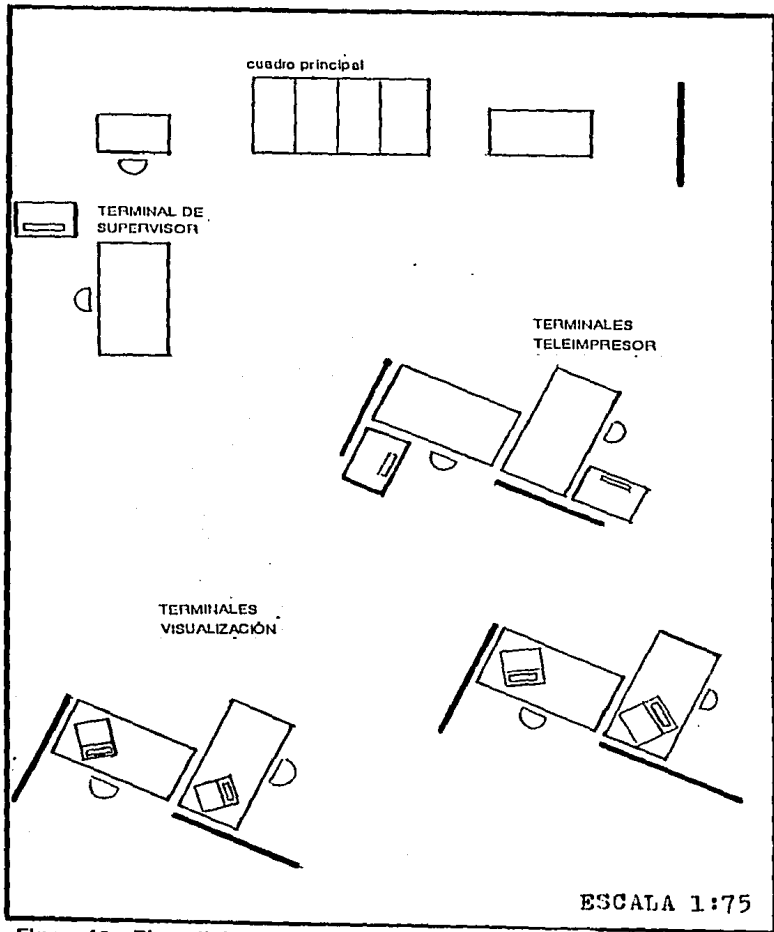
Plano típico de planta de planta para centro O/M PDP-11/34
